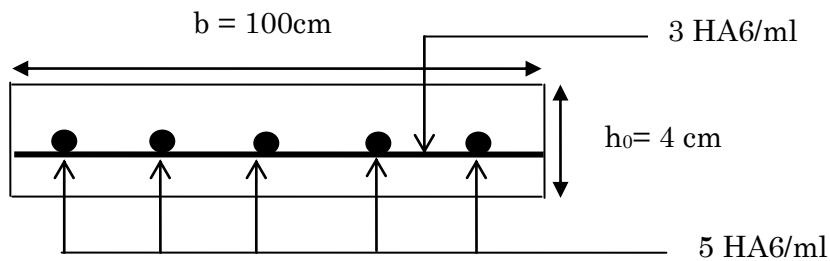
Schéma de ferrailage de la dalle de compression
